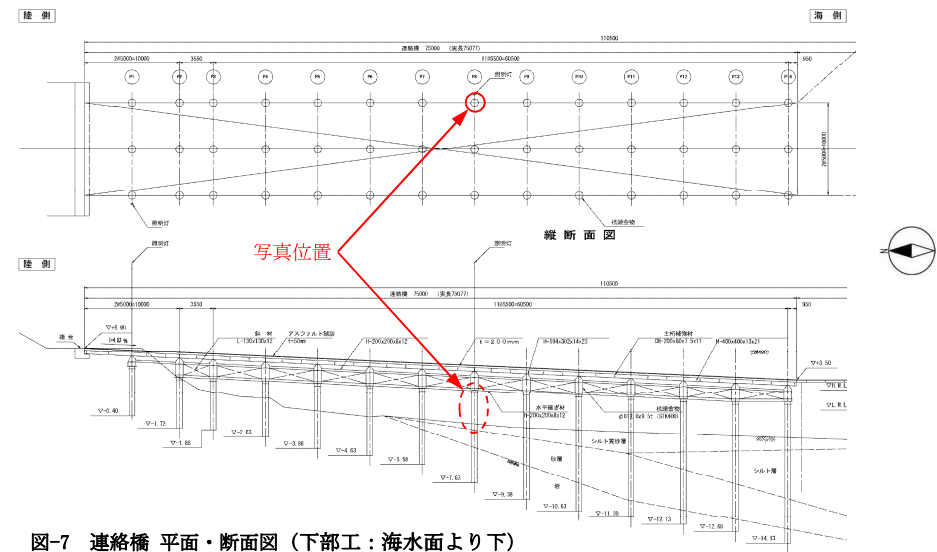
連絡橋 平面・断面図 (下部工：海水面より下)
